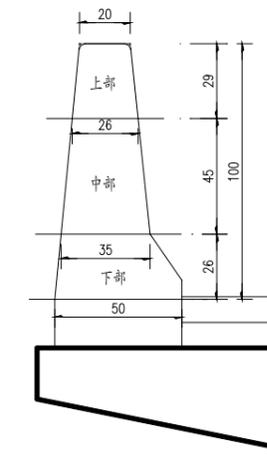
M_w 计算断面图 (尺寸单位: cm)
